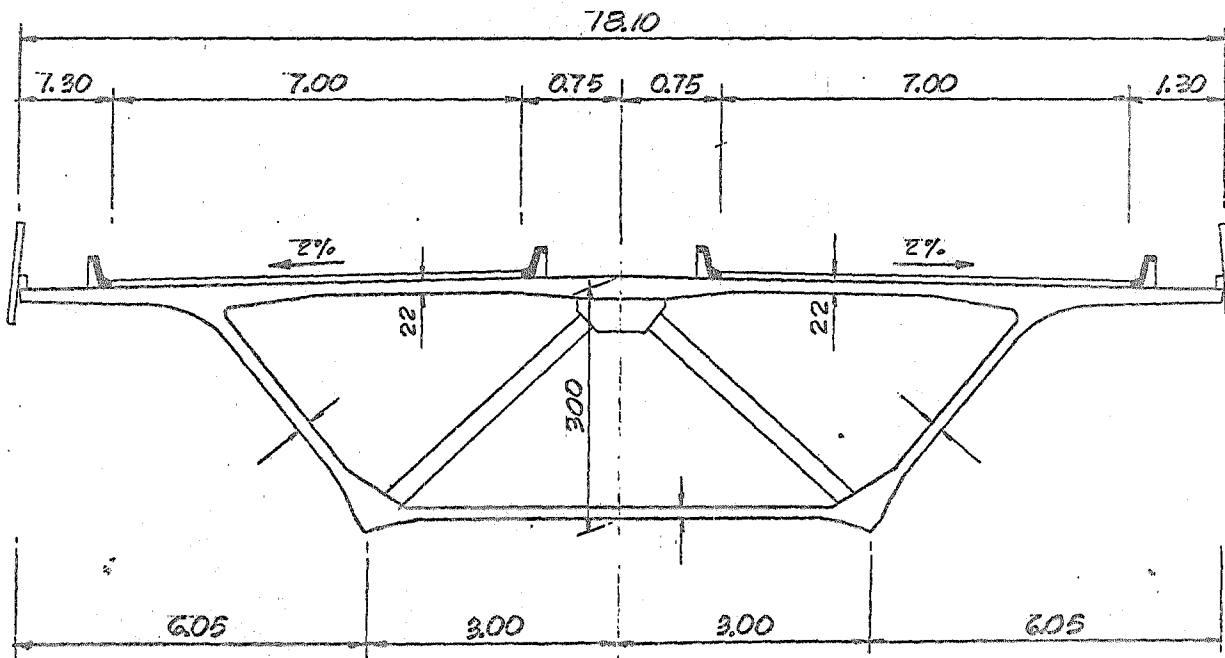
FIG. SECCION TRANSVERSAL DE UNA DOVELA
